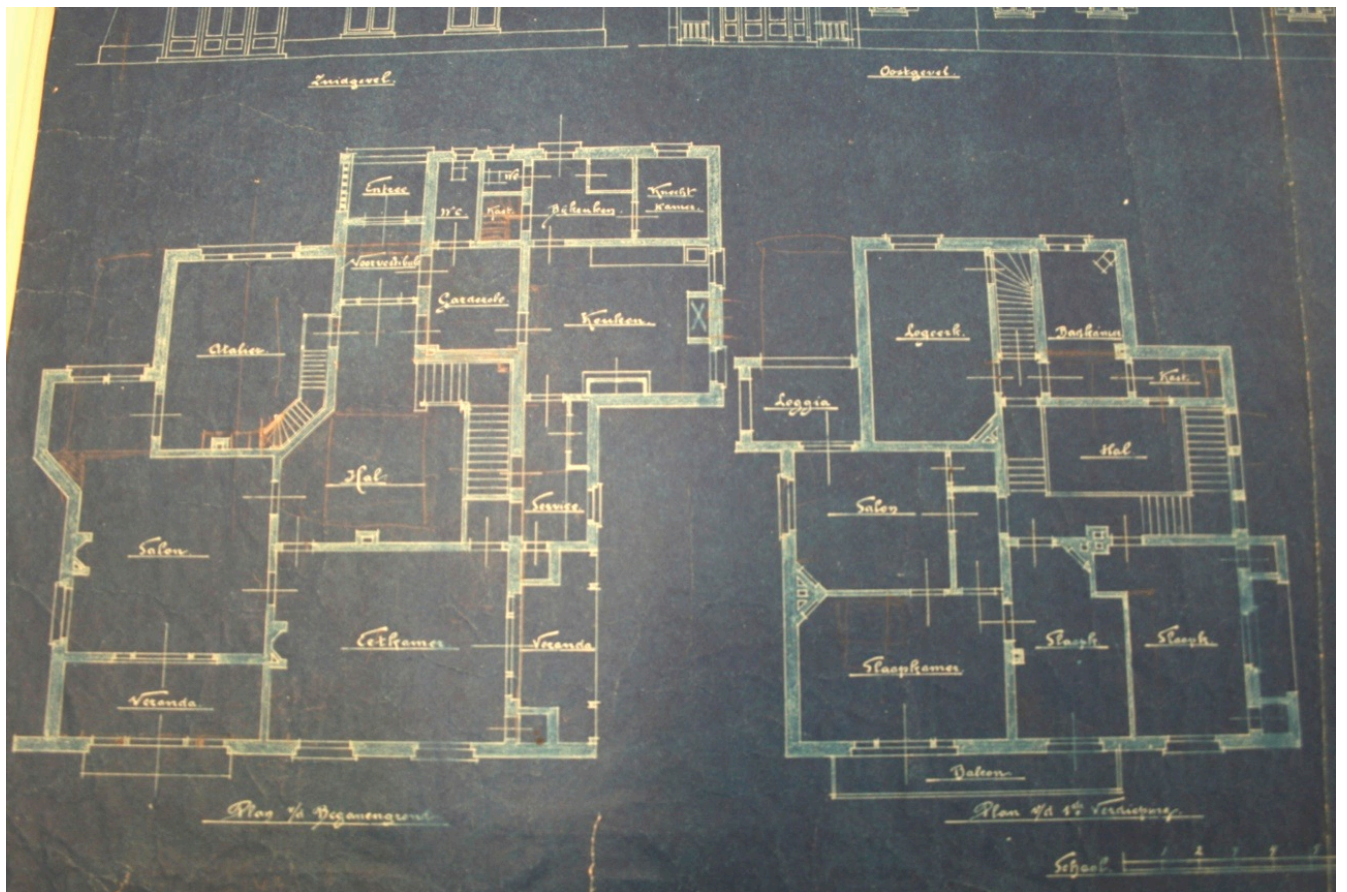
Plan parterre van H.P. Berlage voor het woonhuis van mevrouw L. van Vloten-van Gennep te Noordwijk aan Zee, 1896.
